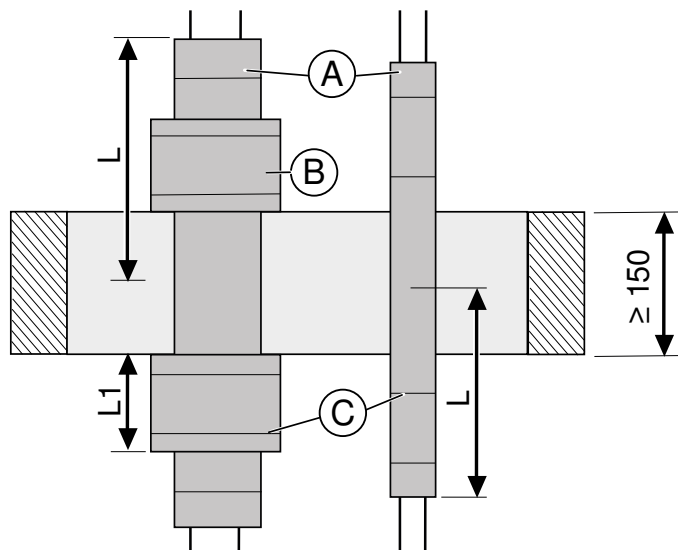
Nichtbrennbare Rohre in Decken mit Strecken- und Schutzisolierung
